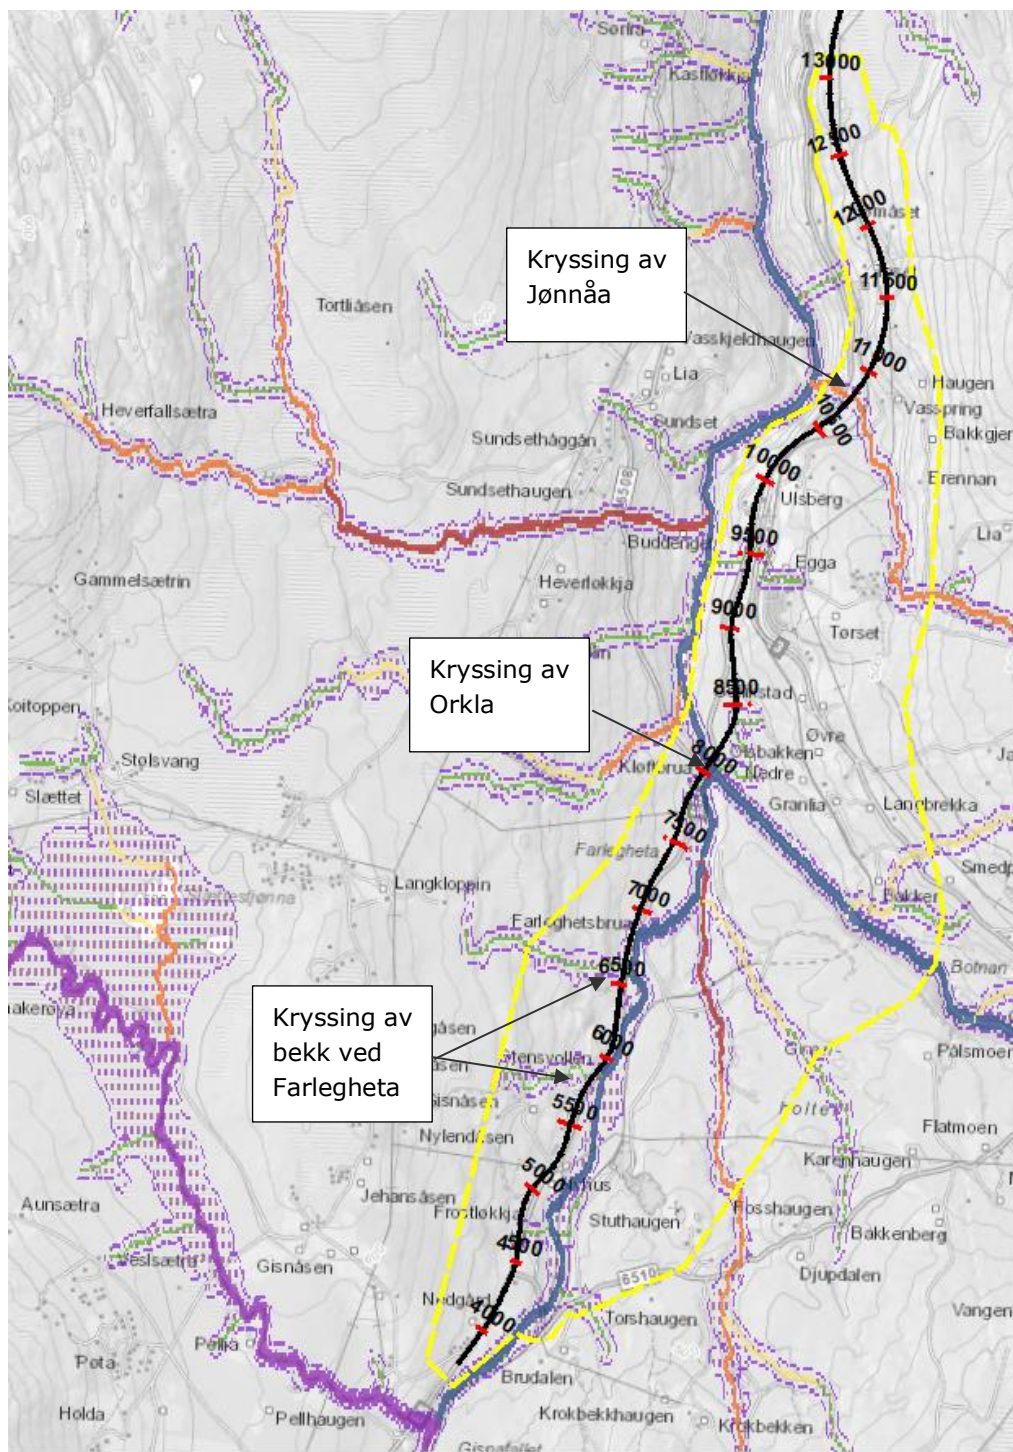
viser planområdet, inkludert eksisterende FKB vanntema.
